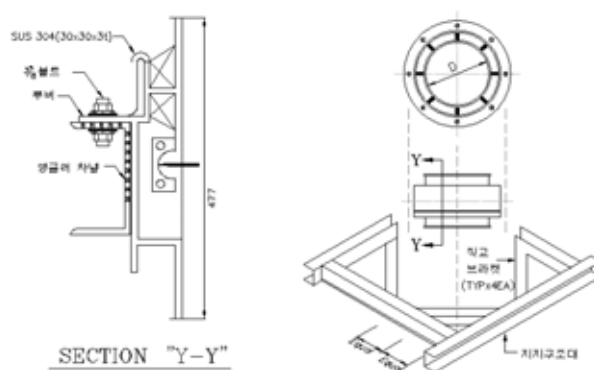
하중 지지대(plate support assembly)와 차널 설치 개념도
